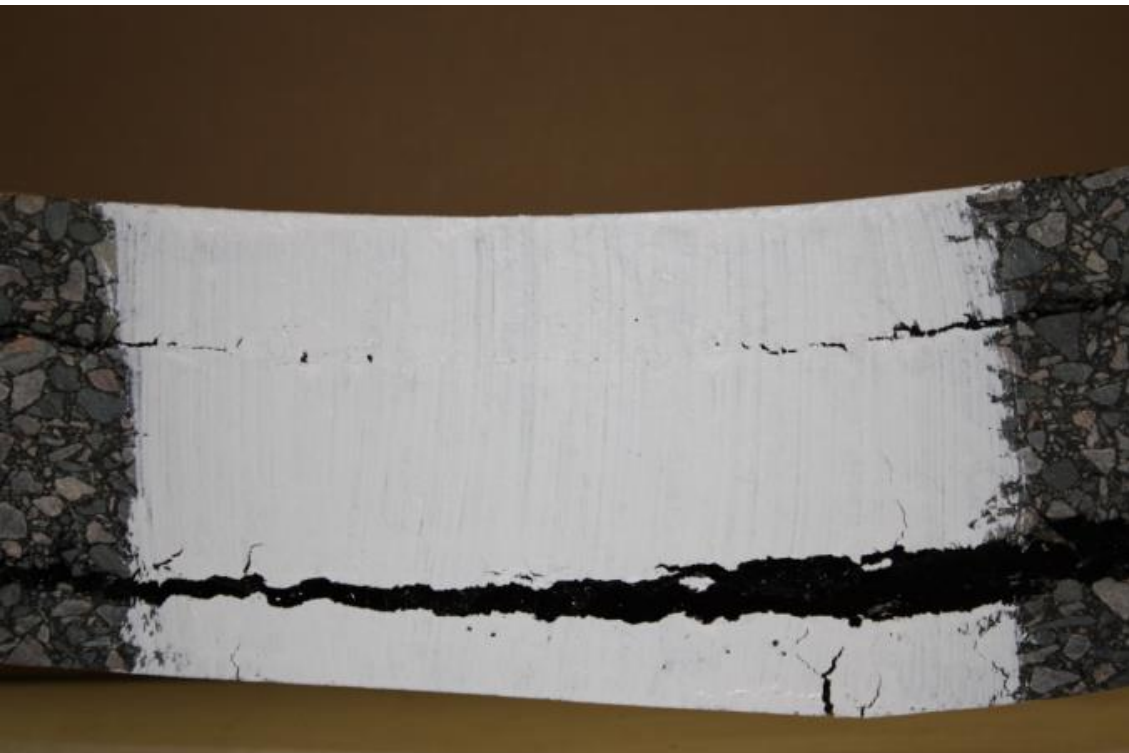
Etat de fissuration après 72h en flexion post-essai 4PB
